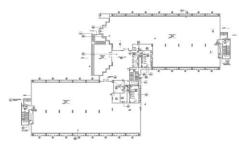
مسقط أفقى لأحد طوابق برج البحرين التجارى العالمي
